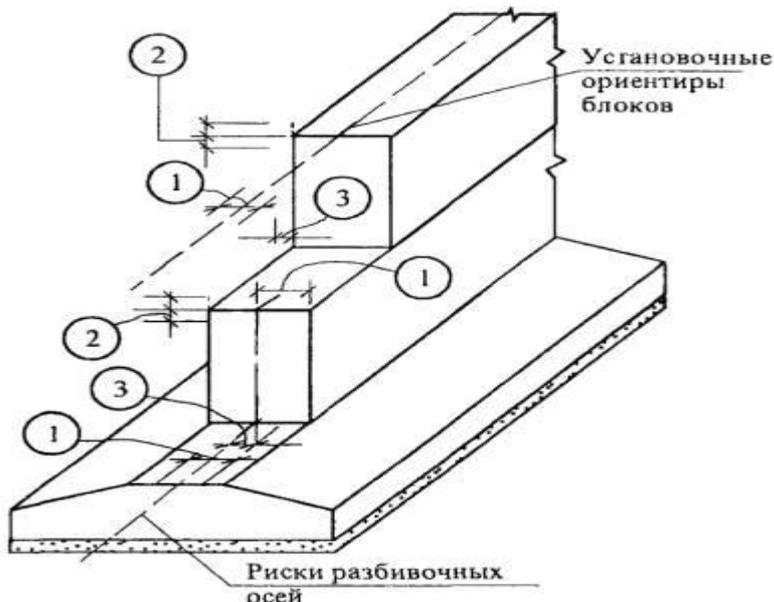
Схема установки рисков на верхние края фундаментных плит и блоков
